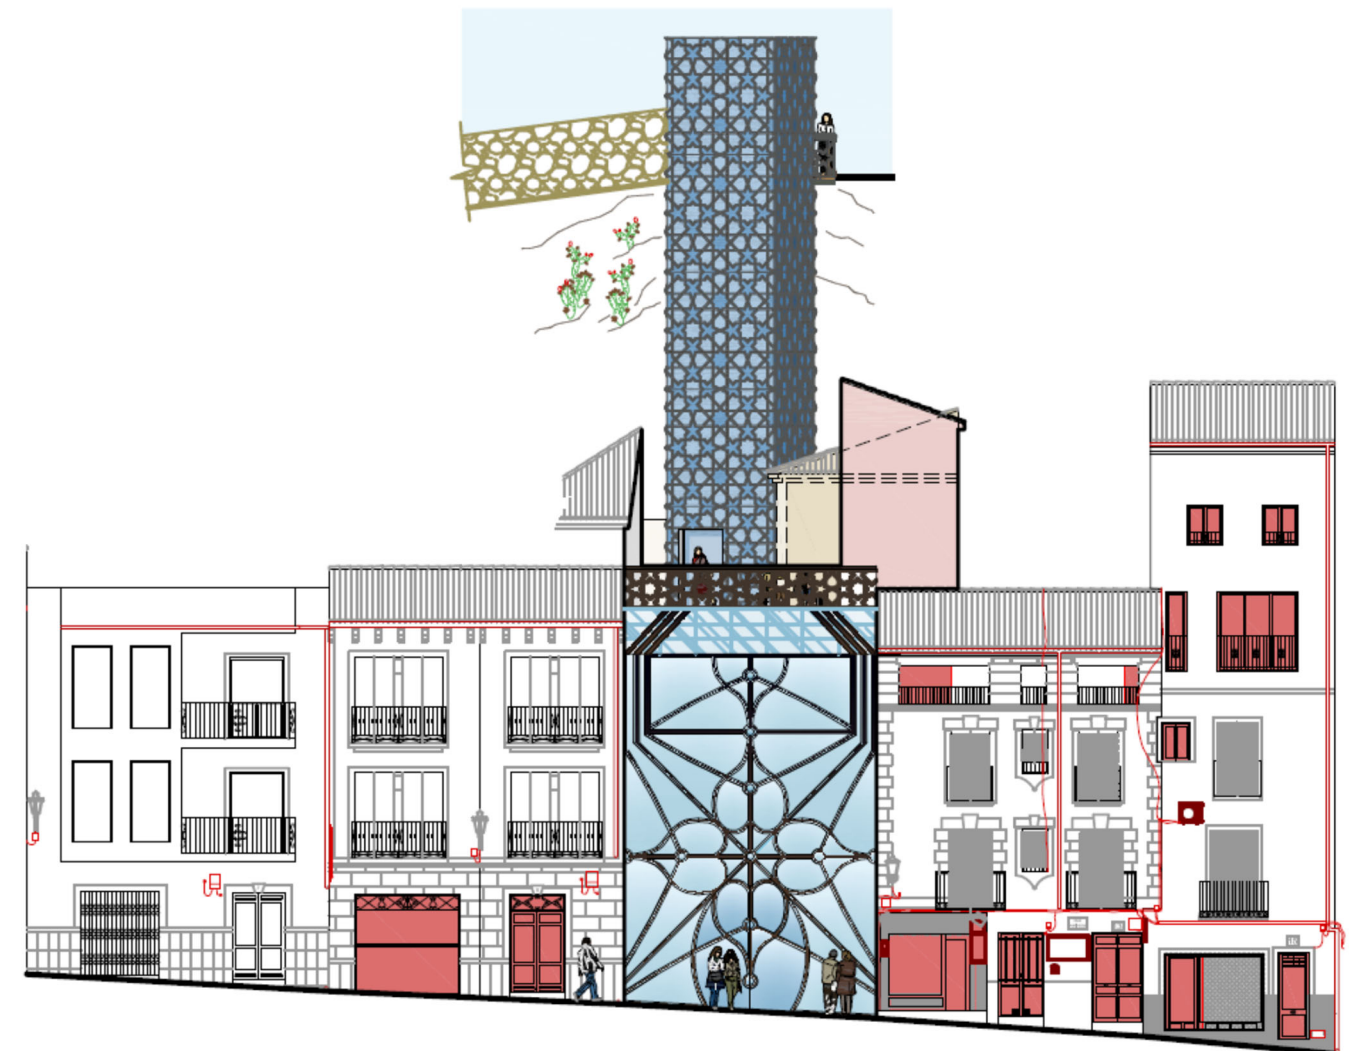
Ha estado reformado con el ascensor en la calle Puentequilla.
